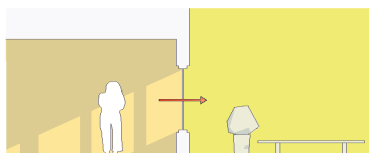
Acristalamiento fachada noreste. Elaboración propia.
